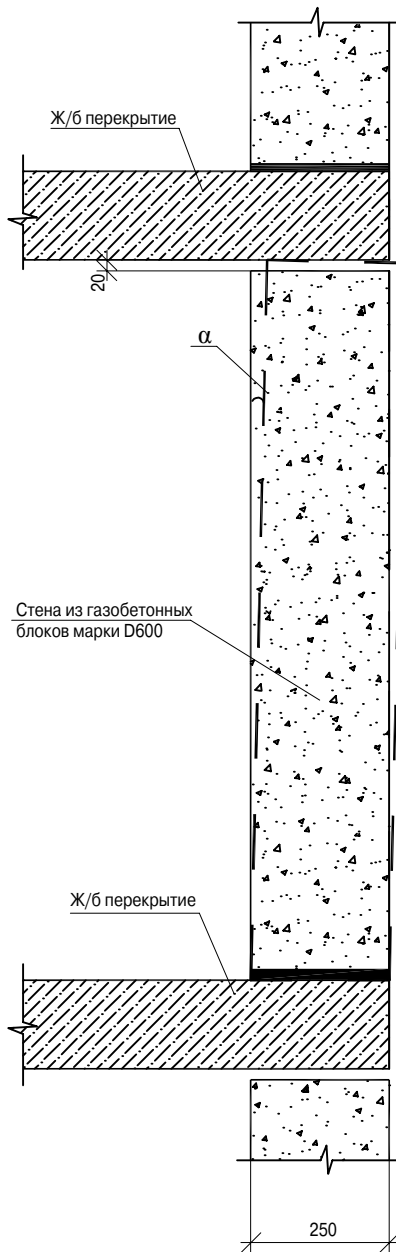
Схема возможного опрокидывания фрагмента стенового заполнения и его заземления верхним перекрытием
